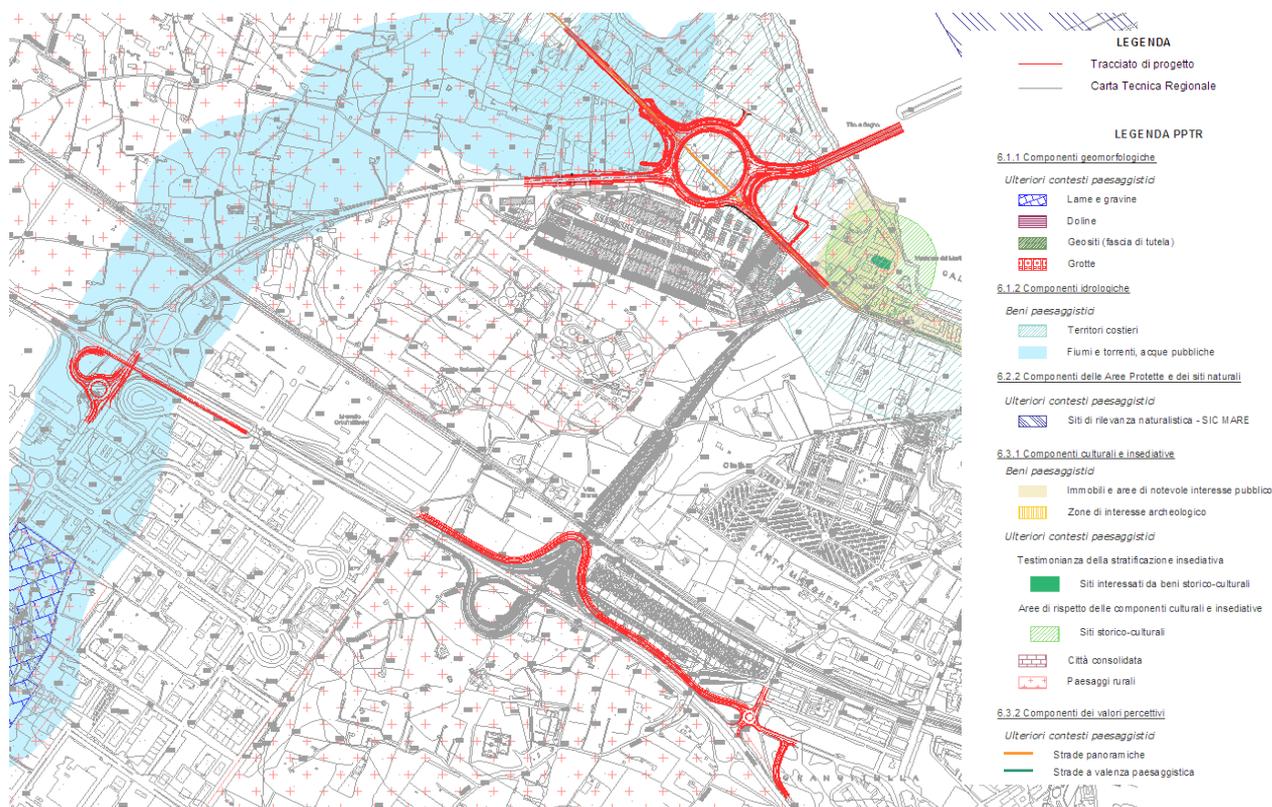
Stralcio della planimetria con sovrapposizione al PPTR Puglia
